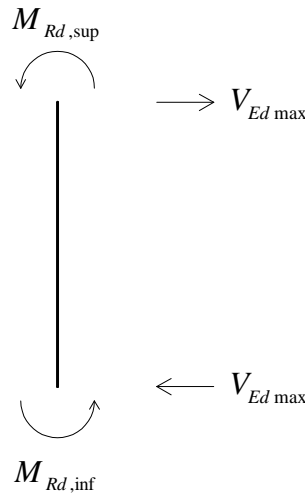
Schema del pilastro con cerniere plastiche alle estremità
